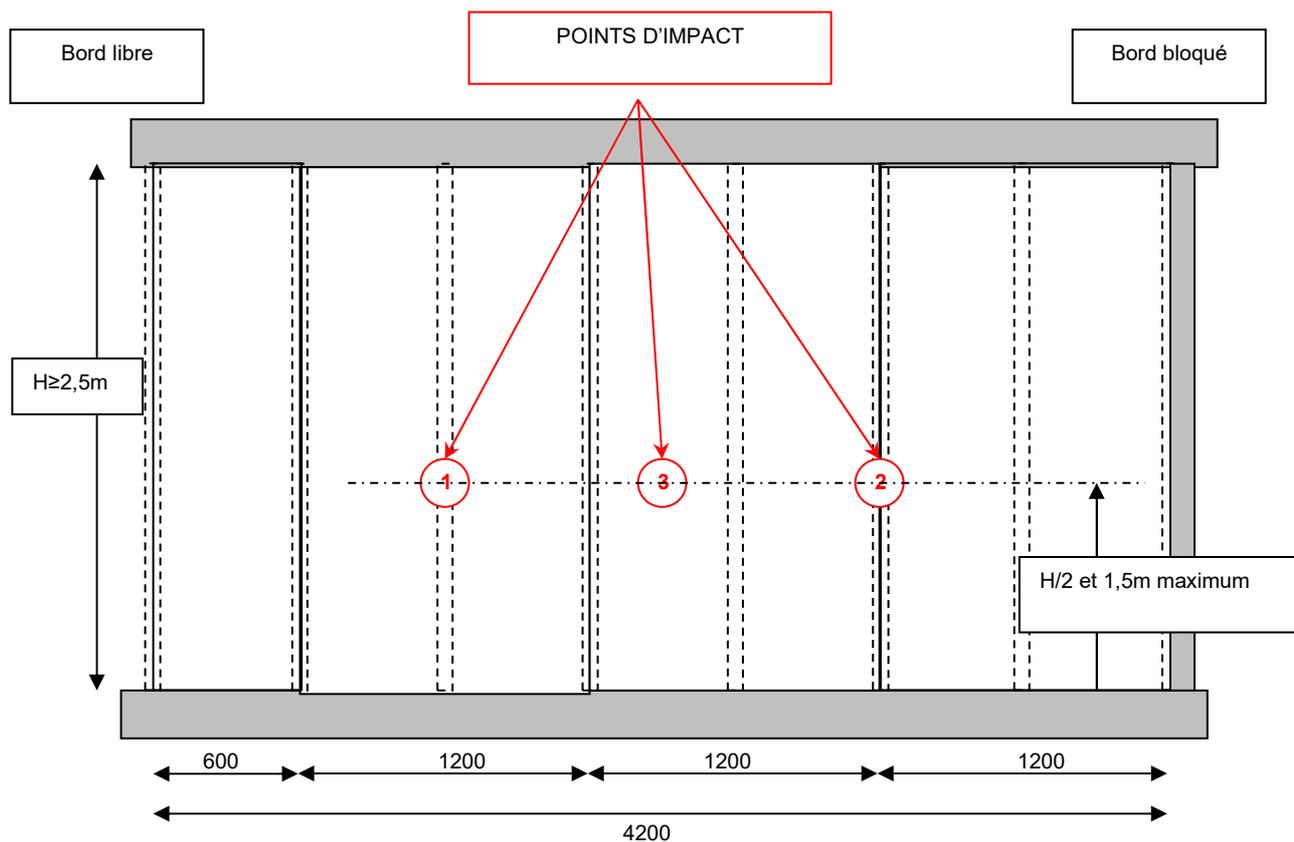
exemple de schéma de montage d'essai avec parements constitués de plaques de 1200 mm et de montants à entraxe de 600 mm
